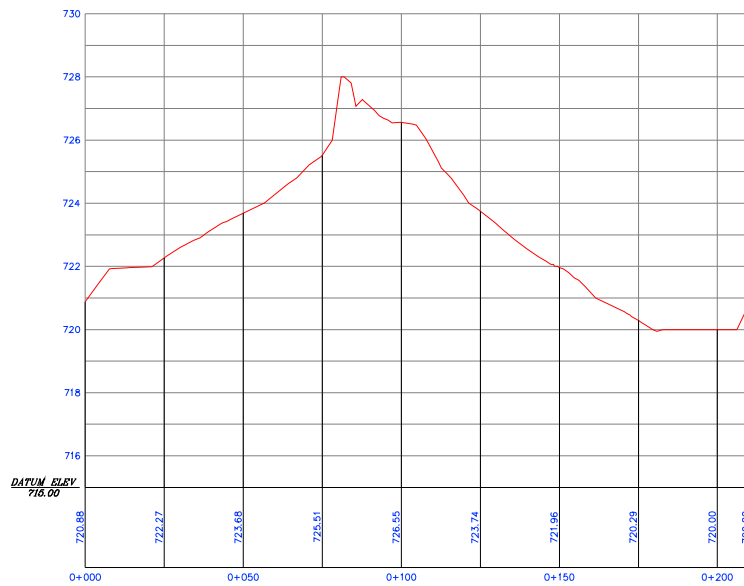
O perfil longitudinal do terreno da Rotunda 1
